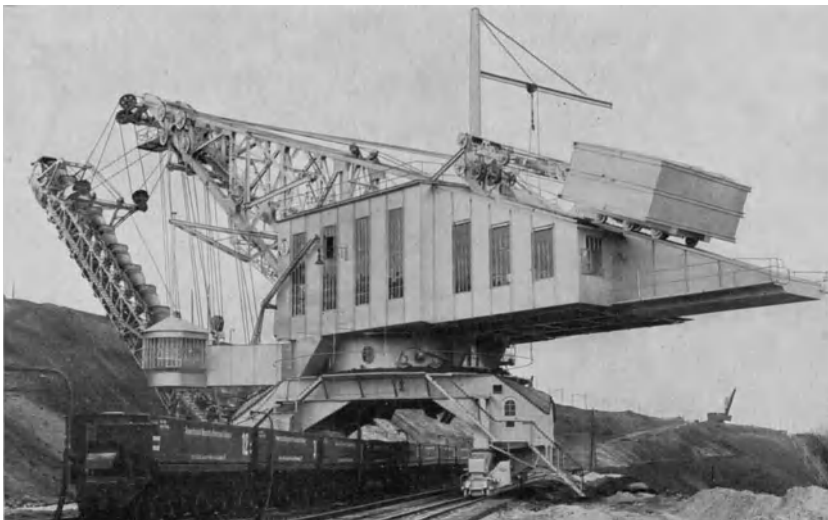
1100 t-Großtor-Schwenkbagger (Buckau).
